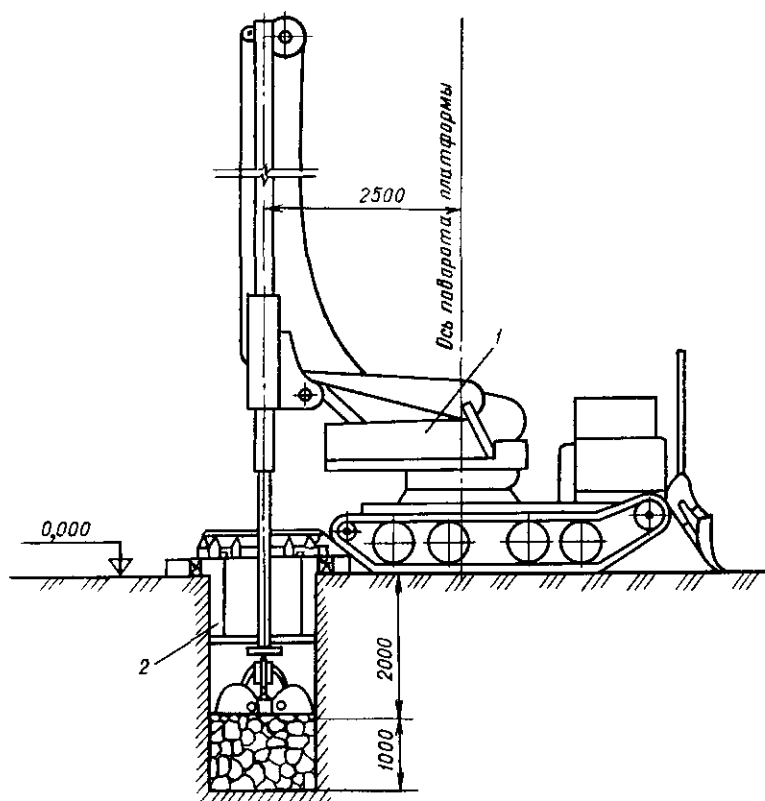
Схема проходки устья шурфа установкой УГШН-15:
